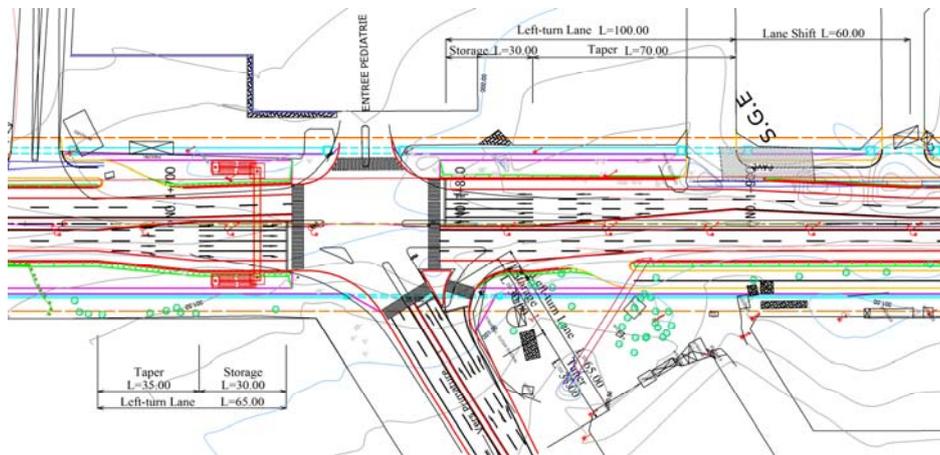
Tracé en plan de l'intersection Charles-de-Gaulle
